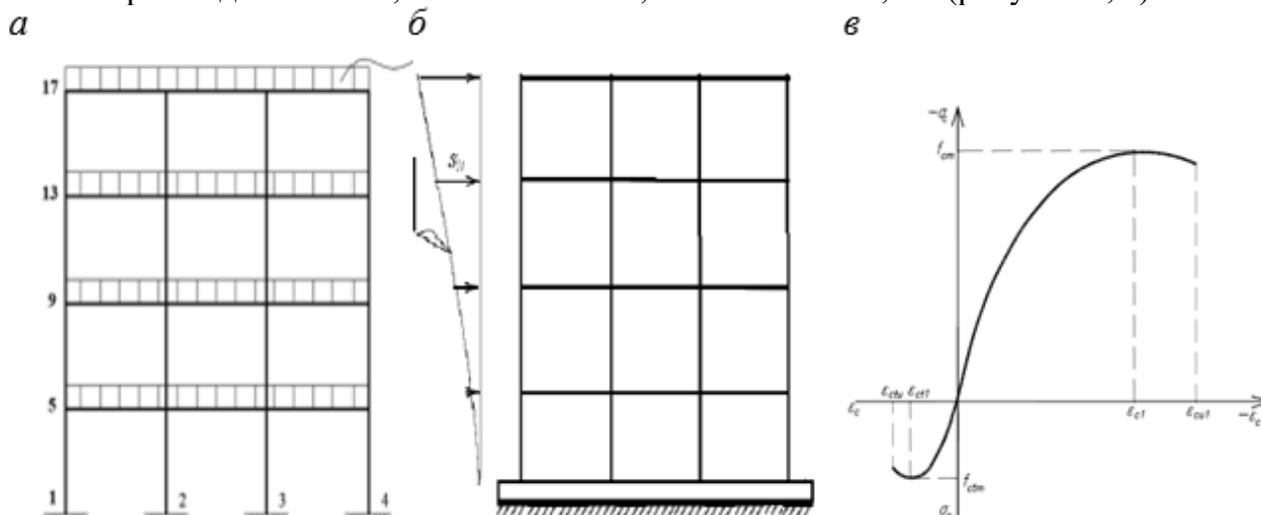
Четырех-этажное здание: а – расчетная схема здания; б – схема загрузки горизонтальной сейсмической нагрузкой по 1-ой форме колебаний; в – диаграмма деформирования бетона
